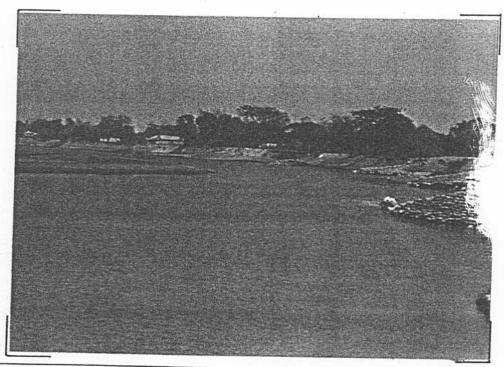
OBRA DE PROTECCION AL DIQUE CON ESPIGONES
